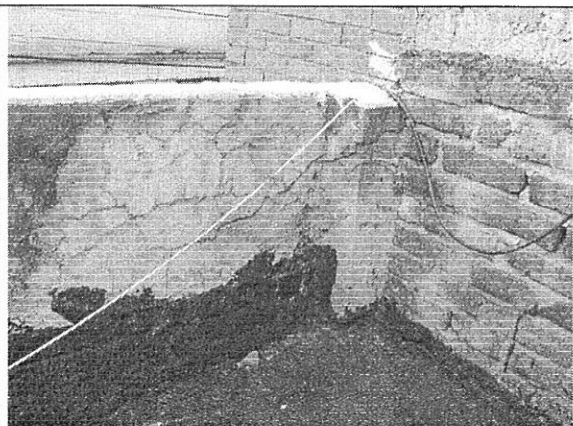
Agrietamiento en parapeto de la azotea
